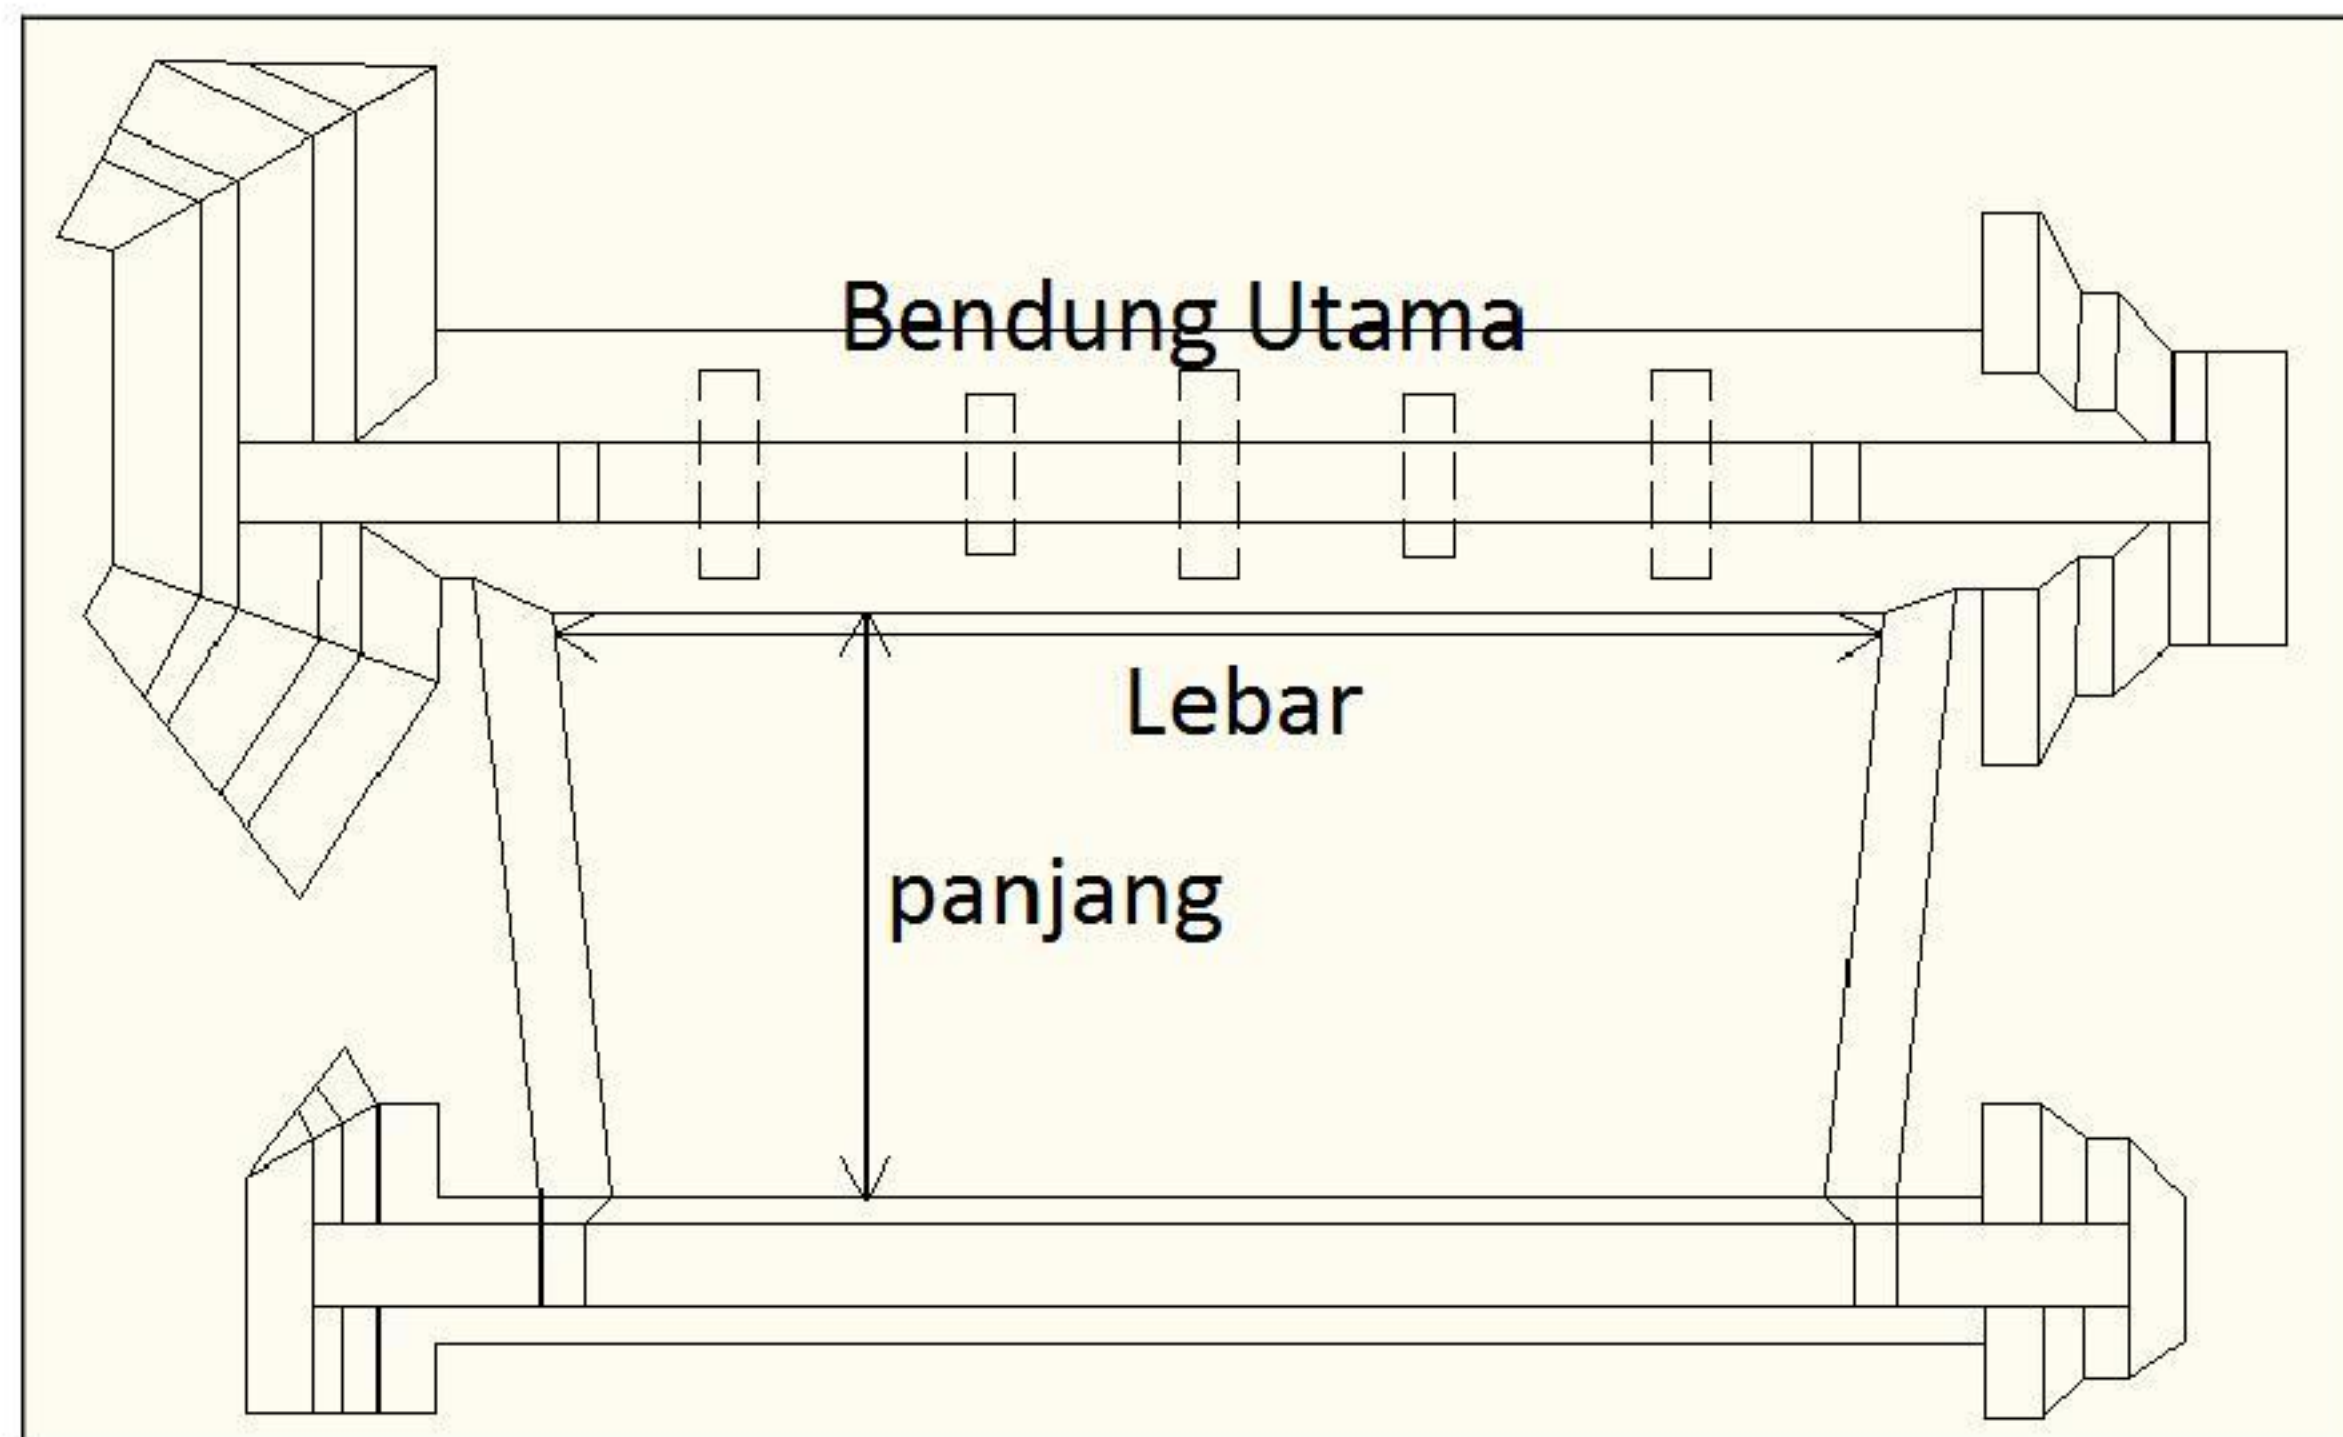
Potongan melintang bangunan penahan sedimen
